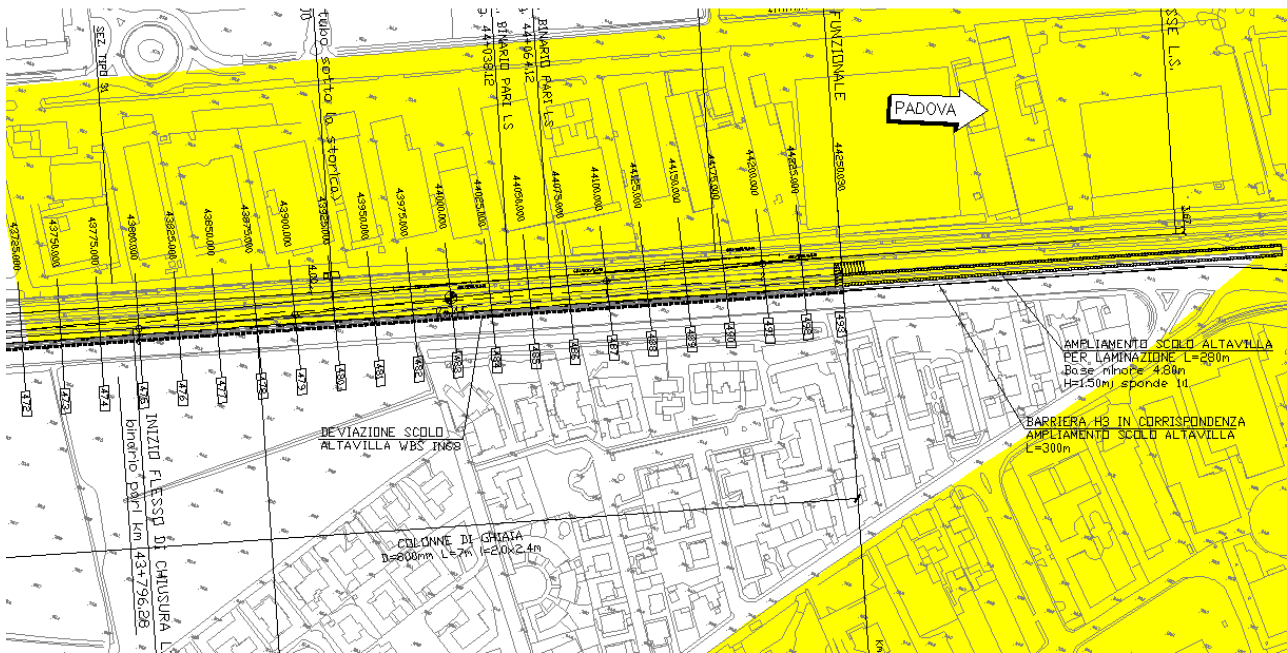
È Estratto dalla planimetria di progetto con l'Indicazione della fascia PAI e l'Indicazione delle sezioni di progetto (rif. tavola IN0D02DI2L6IF0001049D)
